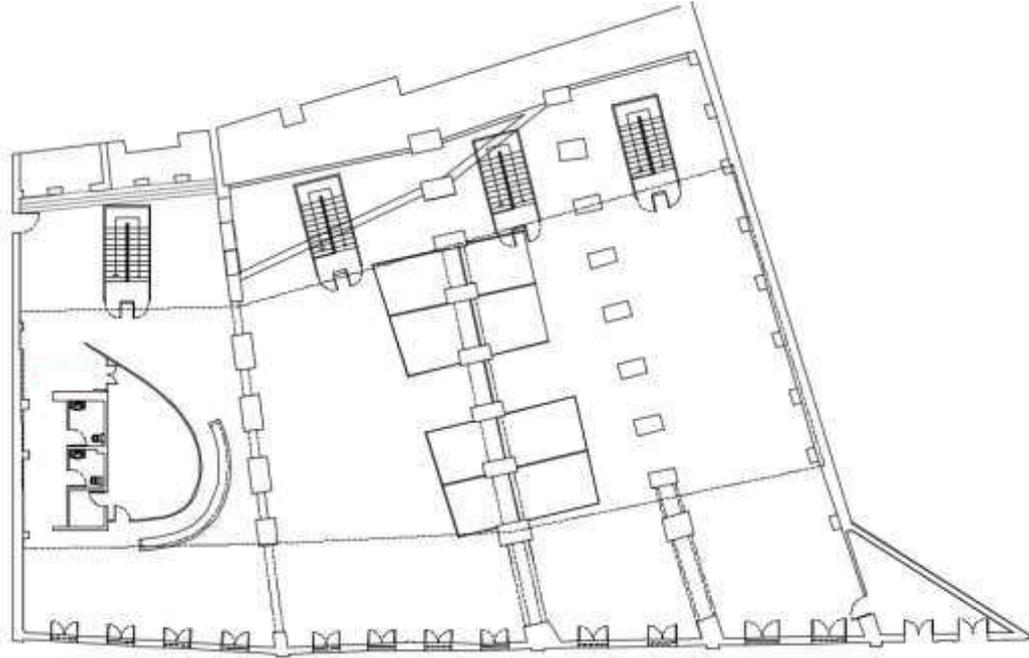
Planta baixa atualizada do prédio Morada das Artes.
